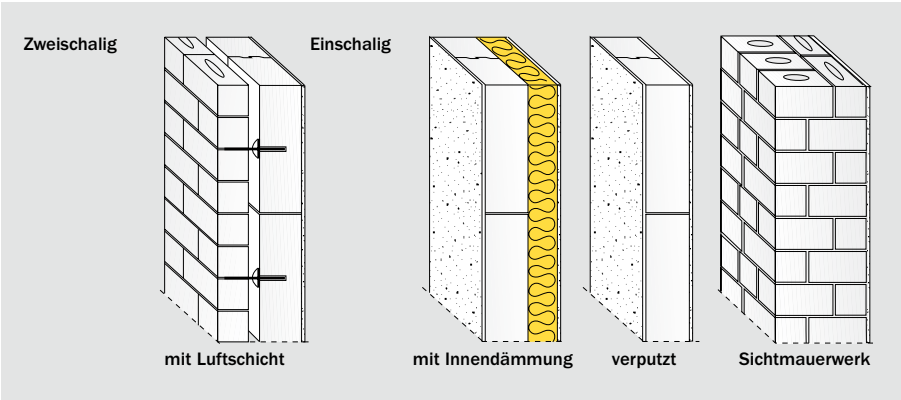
KS-Außenwandkonstruktionen für Sonderfälle
